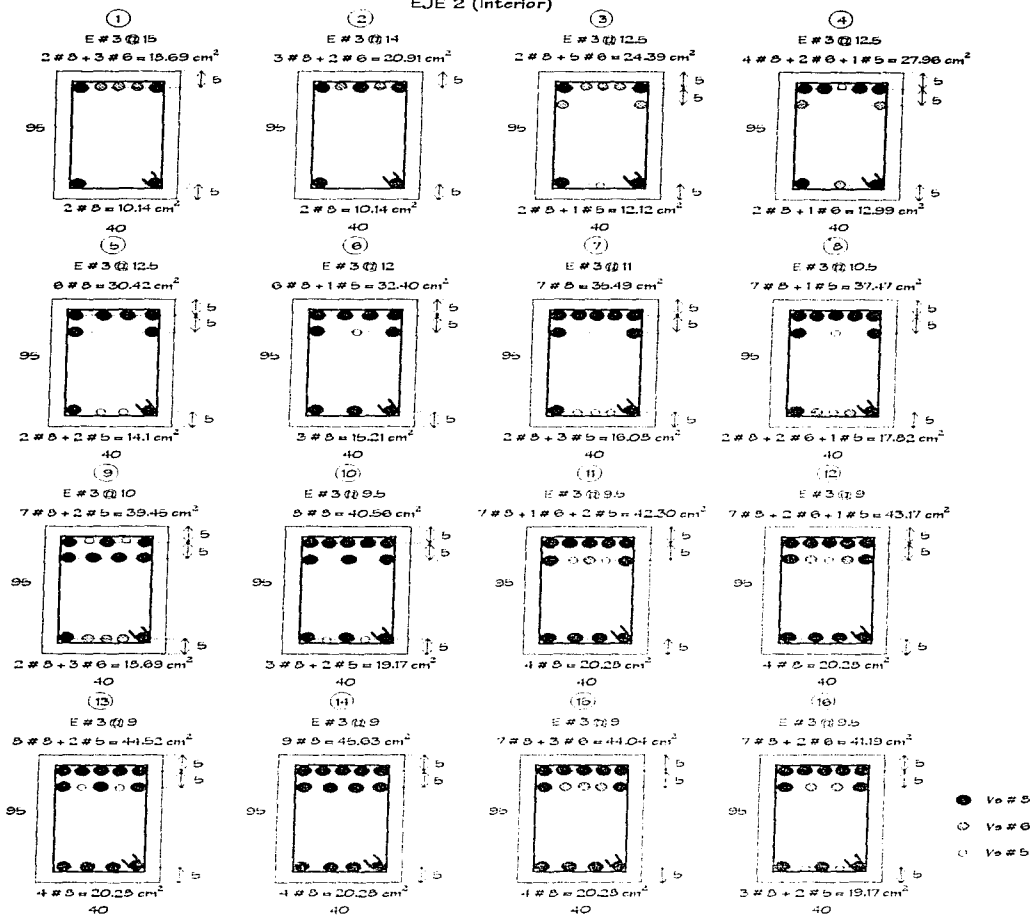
a).- Tipos de armados de las vigas del eje 2 del edificio de 17 niveles diseñado en la zona II
